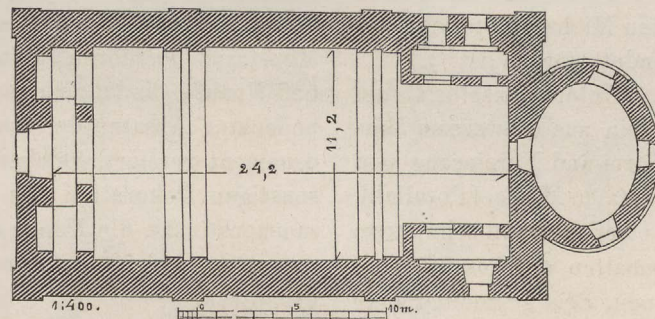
Vandsburg. Grundriss der kath. Kirche.
